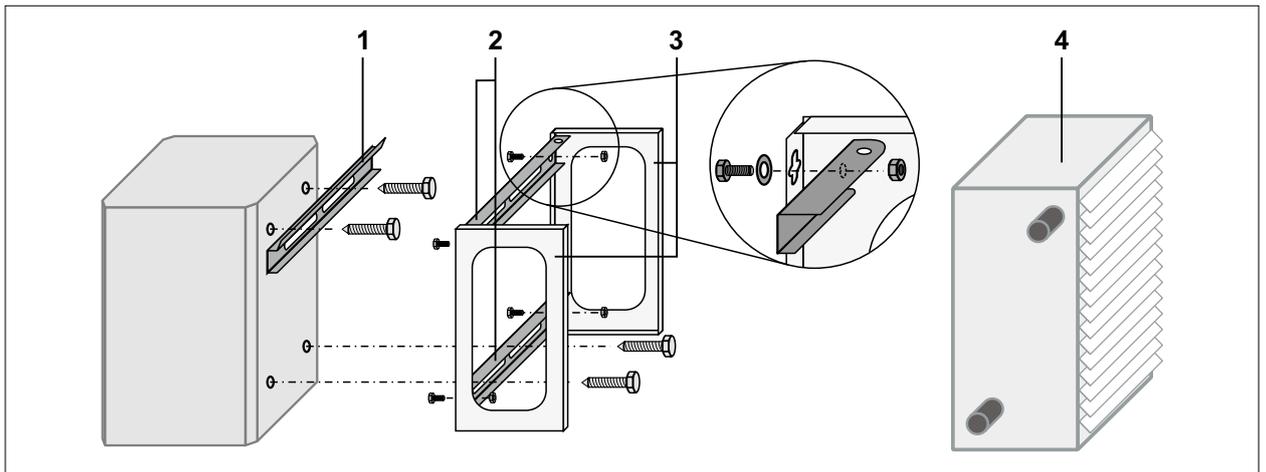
Montaje del aerotermo con el juego de fijación en la viga de hormigón
